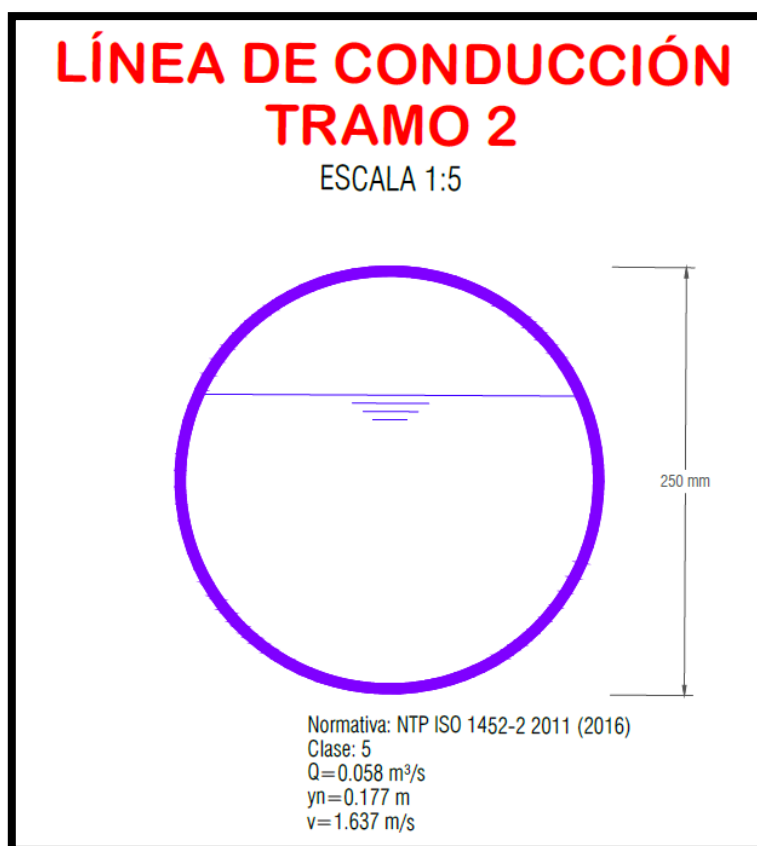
Sección típica de la tubería de PVC-U 250 mm, Tramo 2
